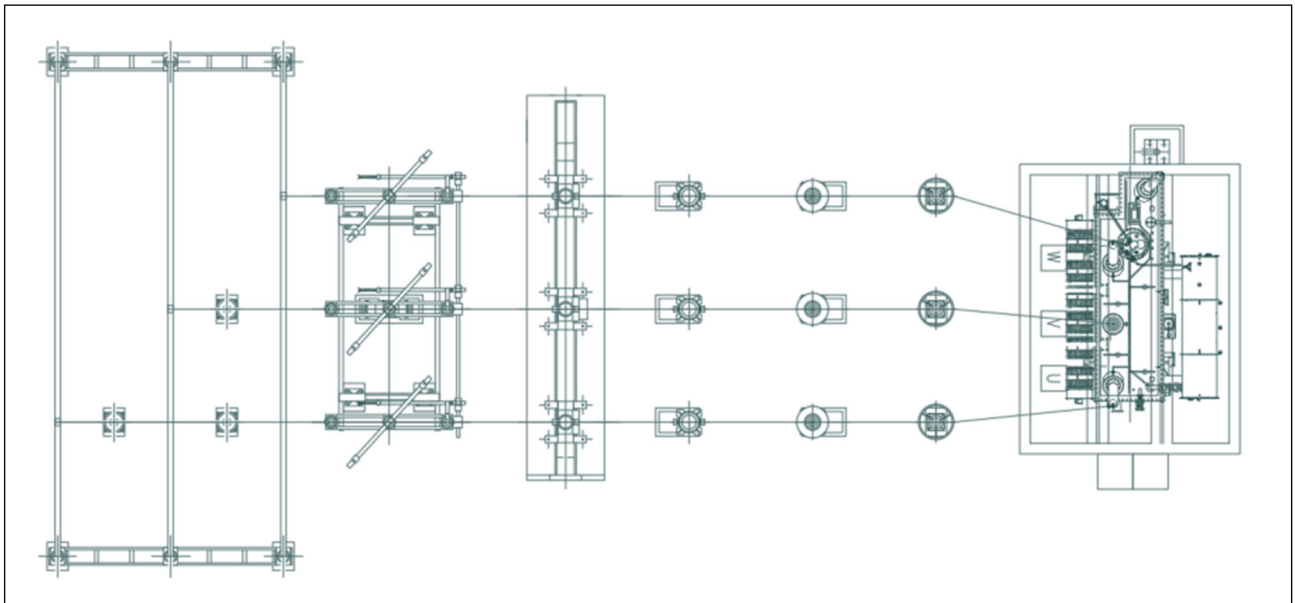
Planimetria elettromeccanica SEU Kinisia 4
